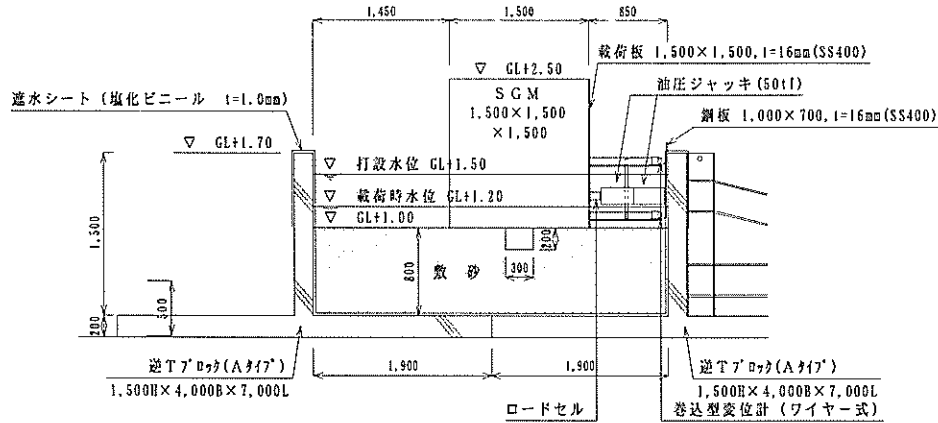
基礎マウンドの断面図（敷砂部 突起付き）
